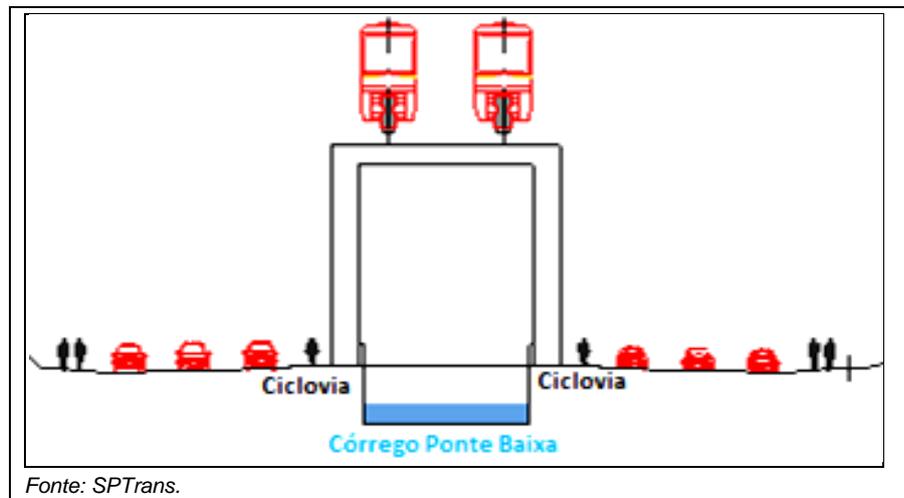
SUB TRECHO AO LONGO DO CÓRREGO PONTE BAIXA
